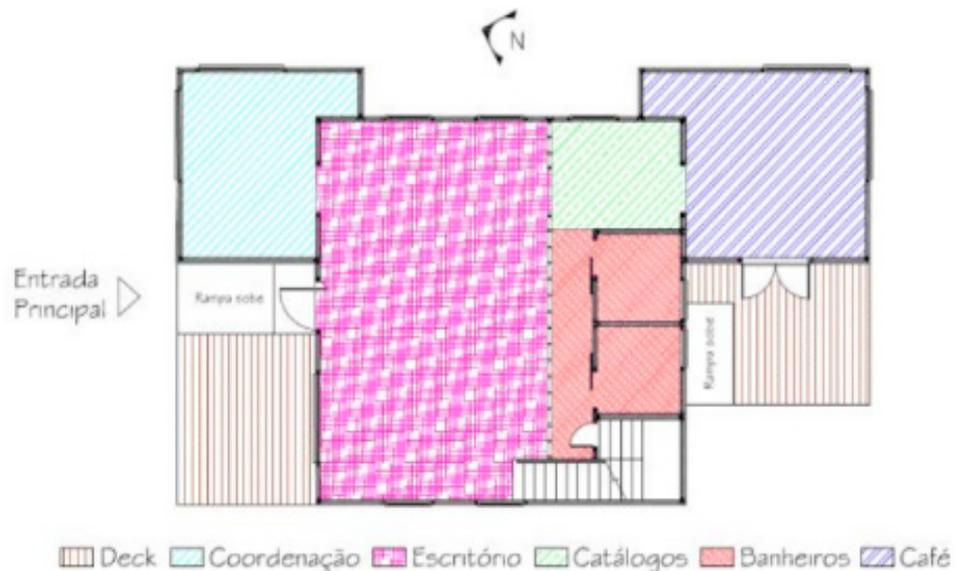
Planta de distribuição de ambientes EV pavimento térreo
